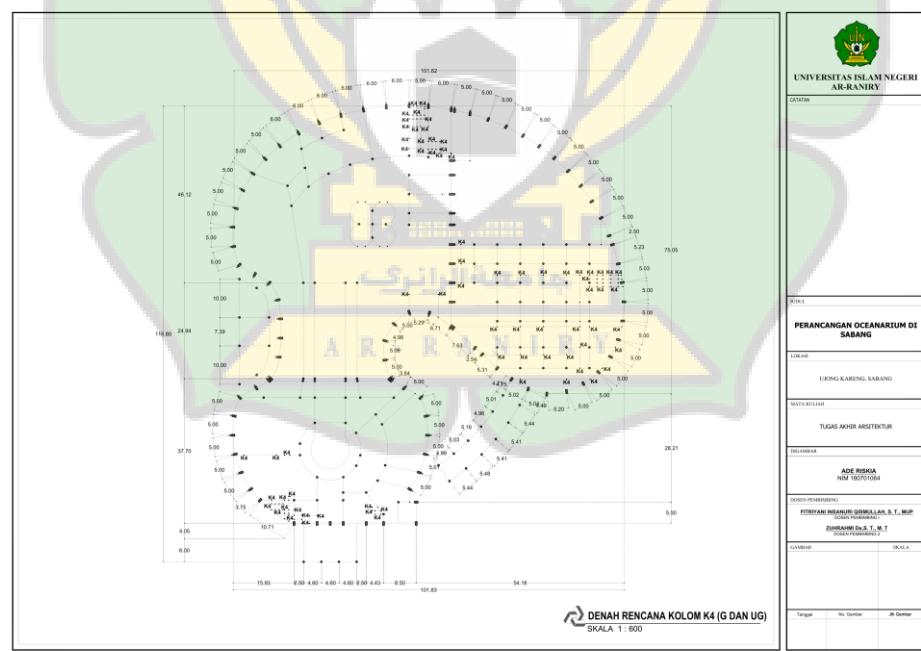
46 Denah Rencana Kolom G dan UG
